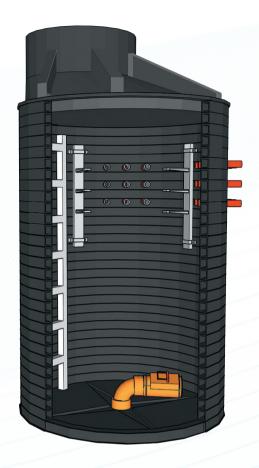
Типовой сварной кабельный колодец FD
